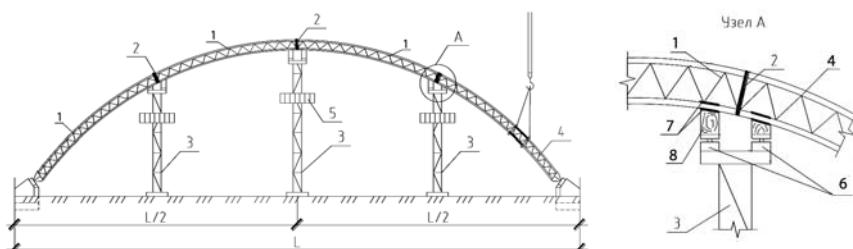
Схема монтажа арочной конструкции с использованием временных опор:
